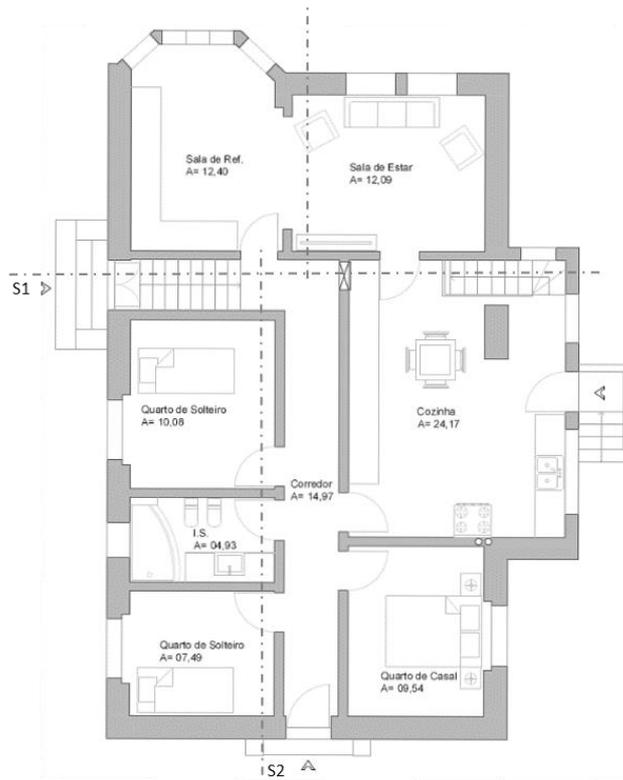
14 - Planta do piso 0 existente, sem escala (Fonte: de autor).
